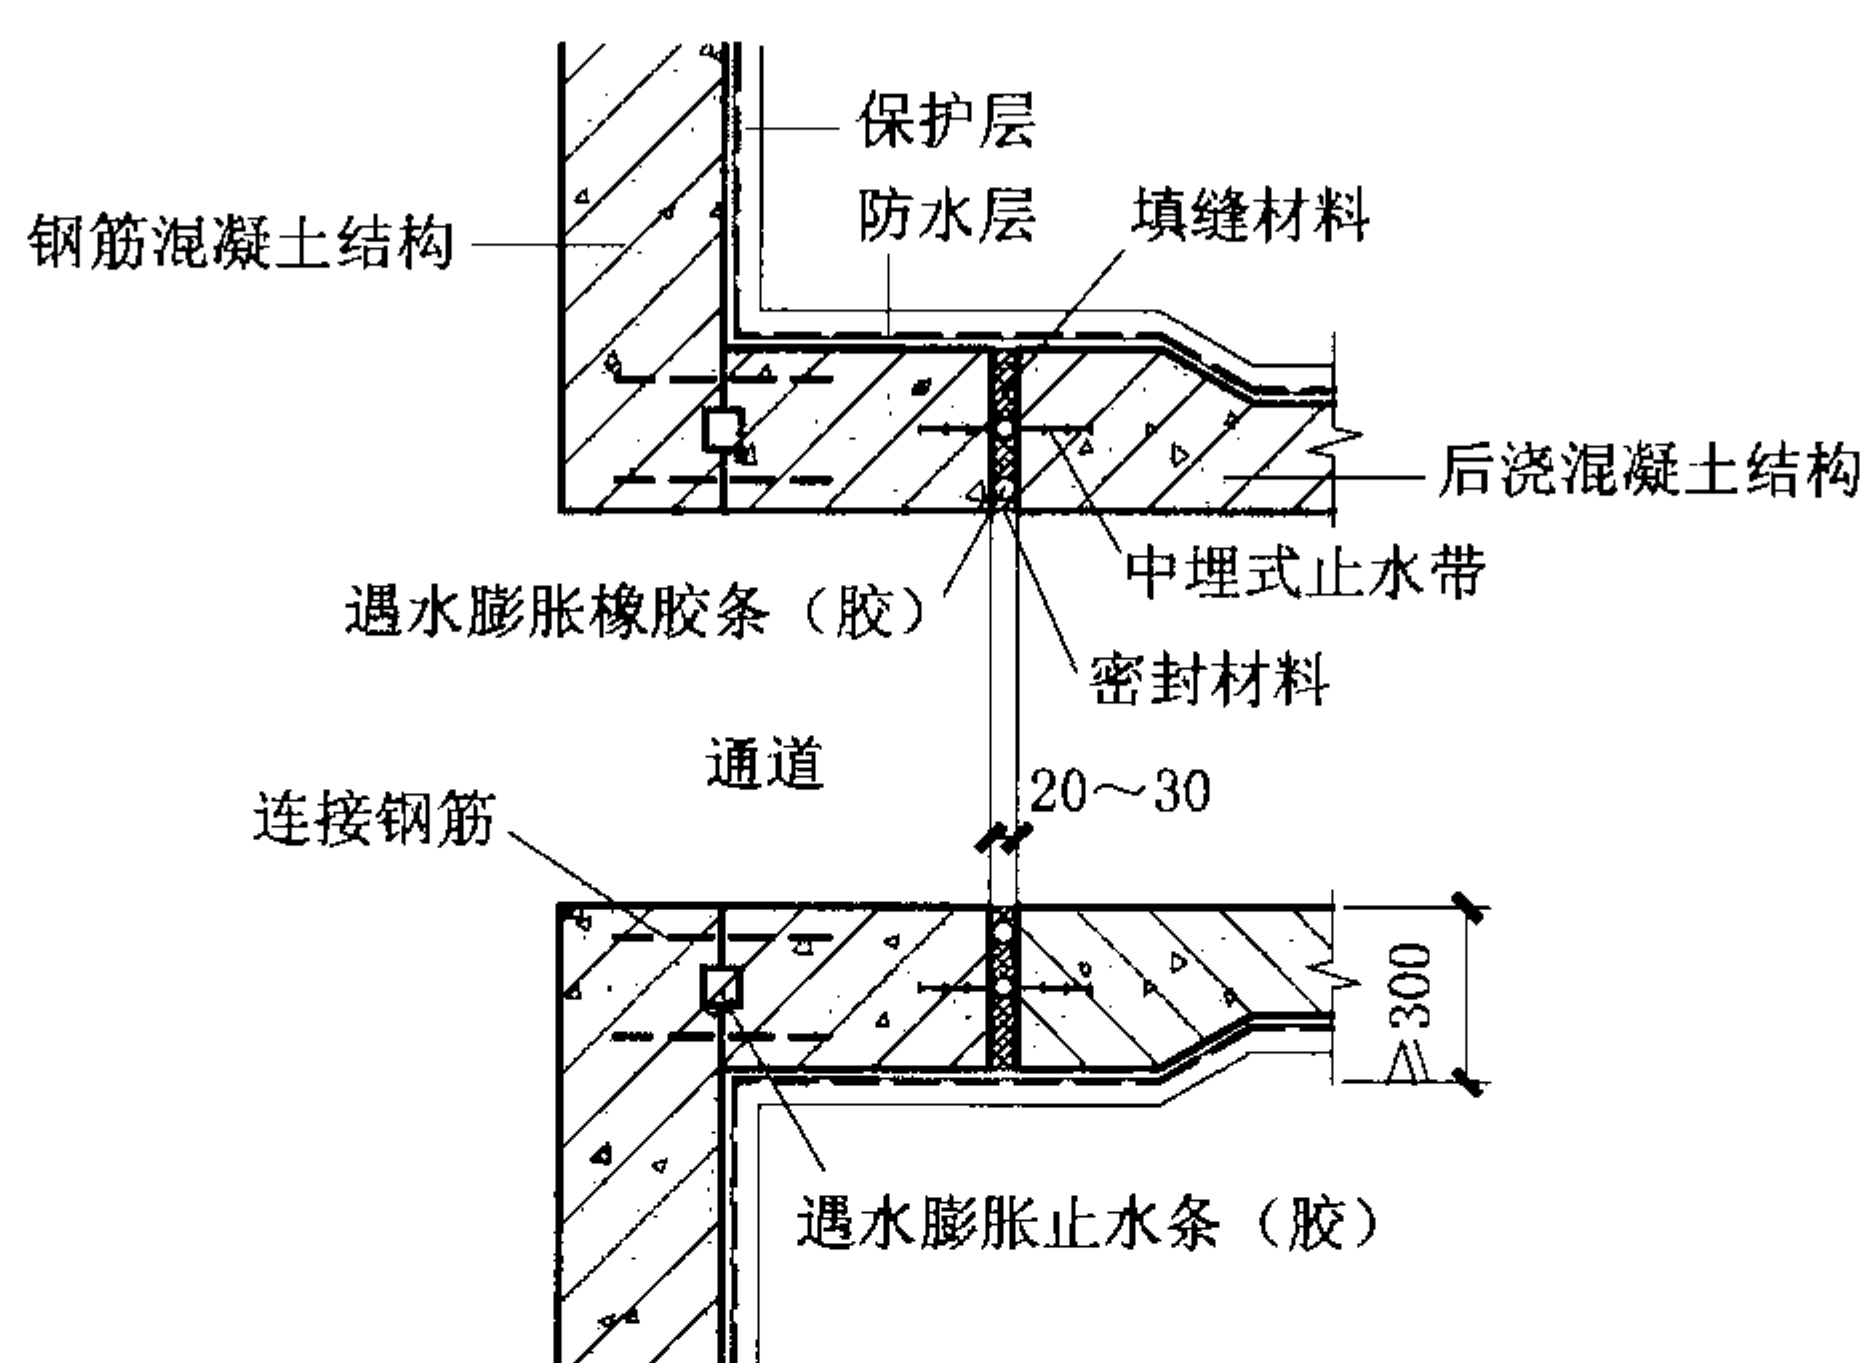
预留通道接头防水构造（其余参见国标图集 10J301）
